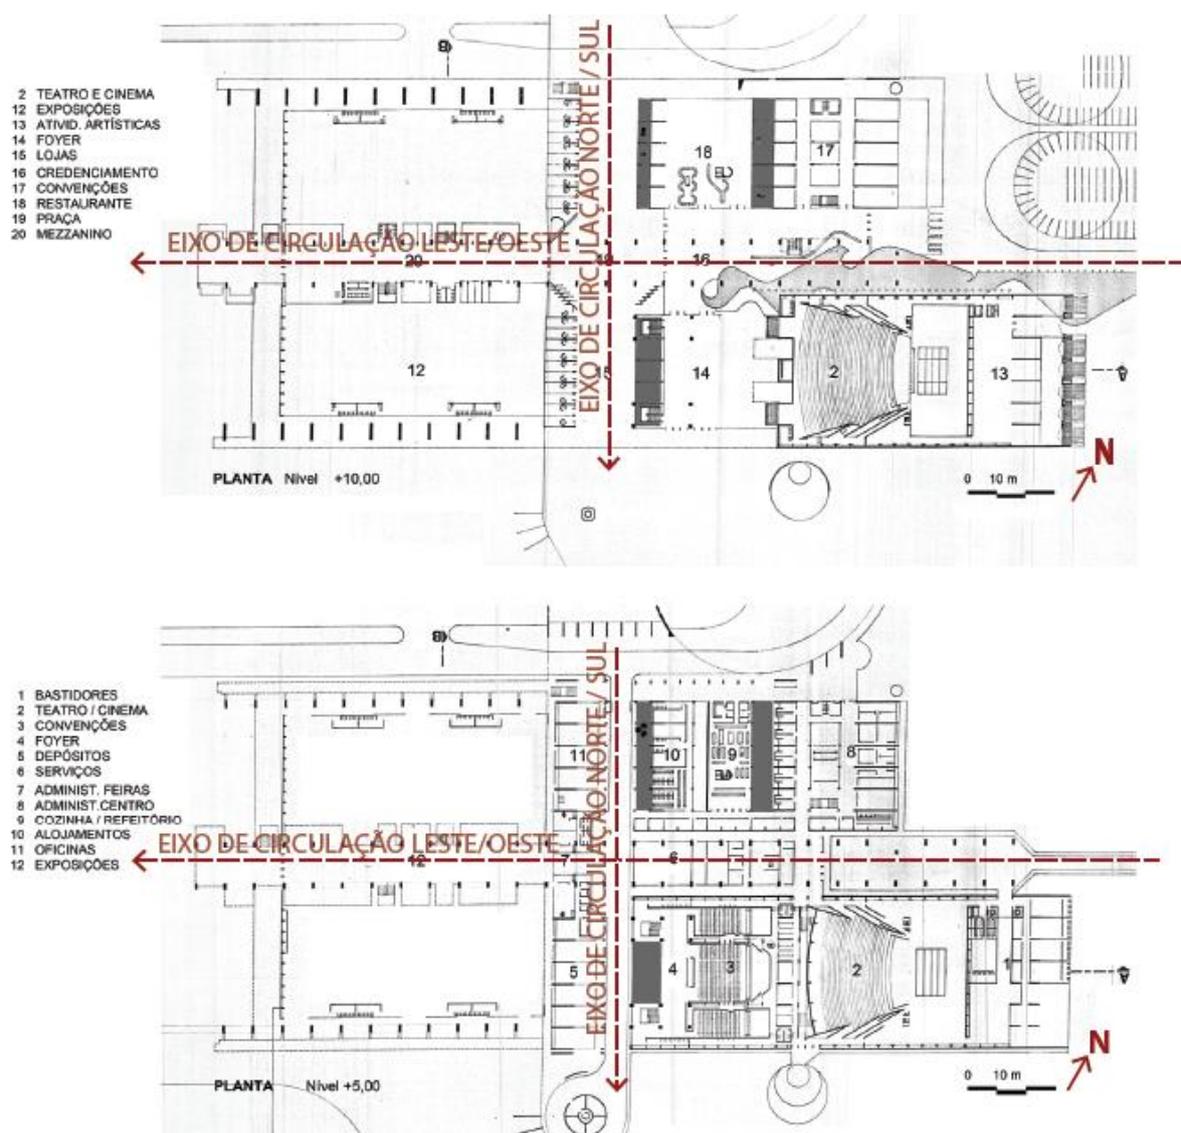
Centro de Convenções de Pernambuco: plantas nível +8,00 e +5,00 do projeto construído.
